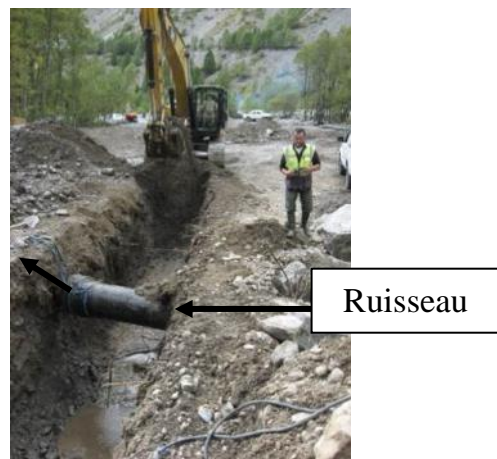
Exemple de passage en sous-œuvre de ruisseau
